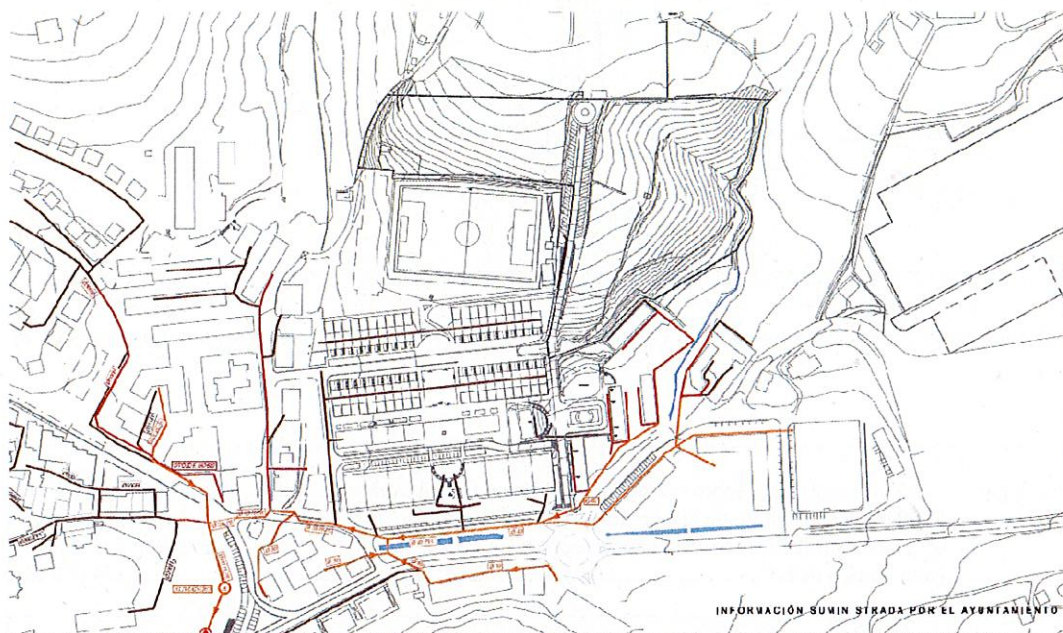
IMAGEN DEL ESTADO ACTUAL DE LA RED DE SUMINISTRO DE EVACUACION DE AGUAS RESIDUALES: PLANO B.2.1.5
